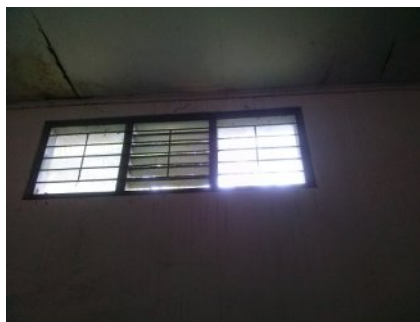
Fentilasi Area Ruang Kerja *Engine
